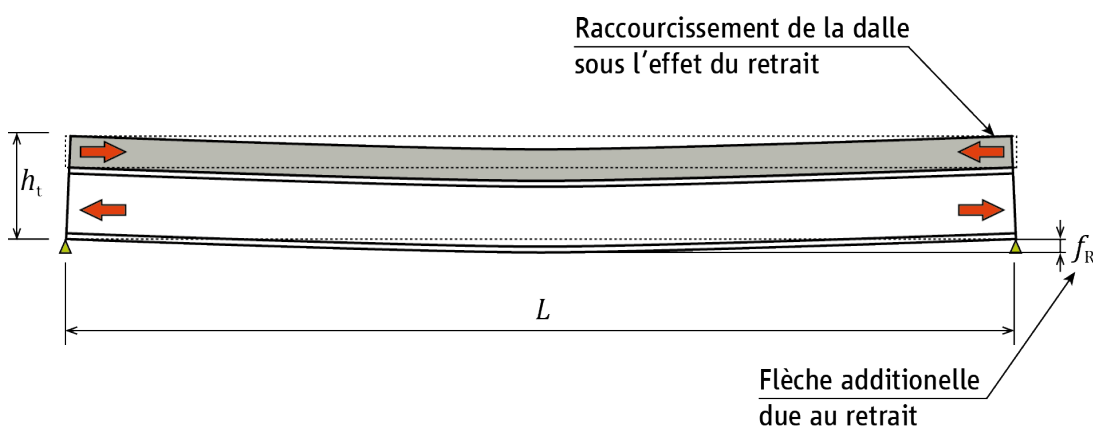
Flèche d'une poutre mixte due au retrait du béton dans la dalle
